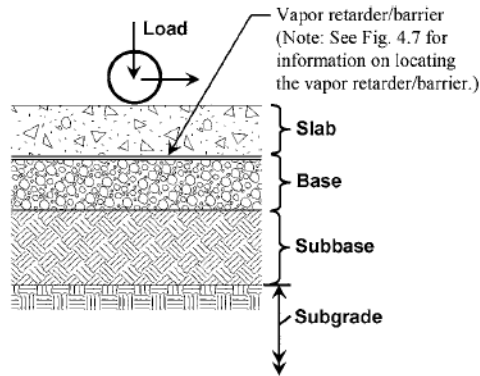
Sistema de soporte de suelo para una losa (ACI 360, 2016)
